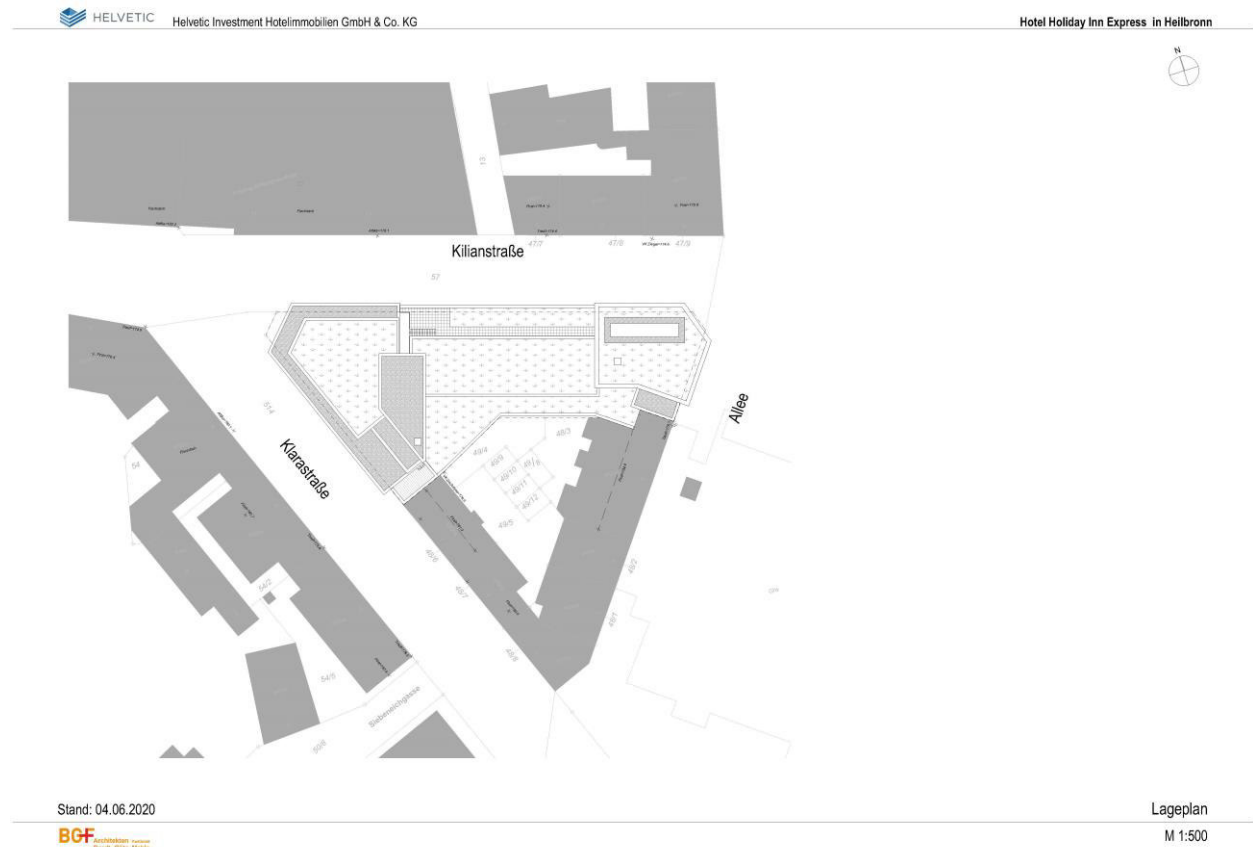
Lageplan zum Planvorhaben Kilianstraße 14 + 20 in Heilbronn (Quelle: BGF+ Architekten; Stand vom 04.06.2020).
